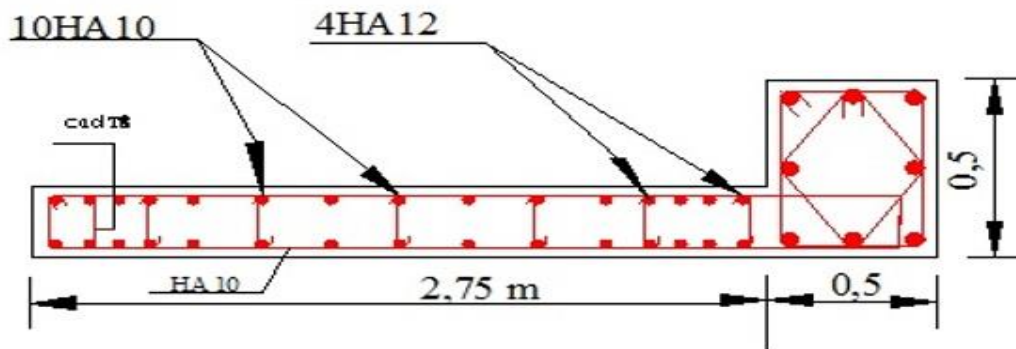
Schéma de ferraillage des voiles sens longitudinal « RDC ».
